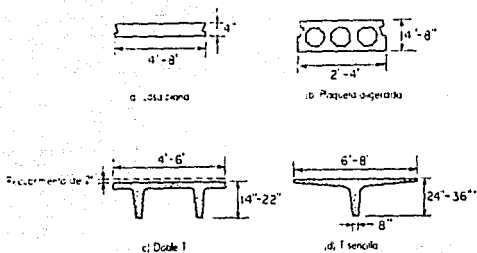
ELEMENTOS PREFABRICADOS DE CUBIERTA Y DE ENTREPISO.
